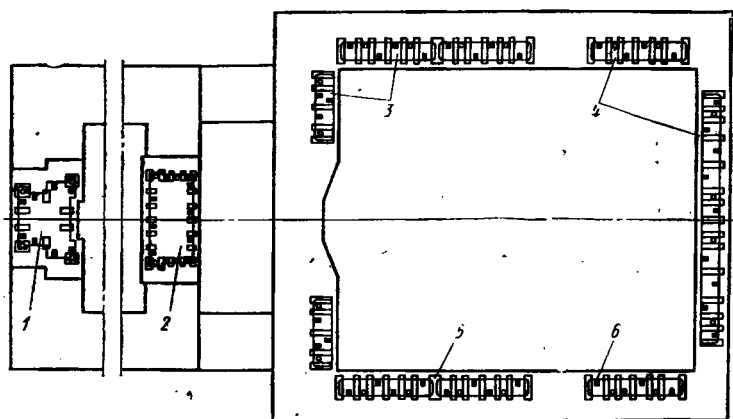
Схема расположения закладных опорных плит и клиновых домкратов под фундаментными рамами турбины К-300-240:
